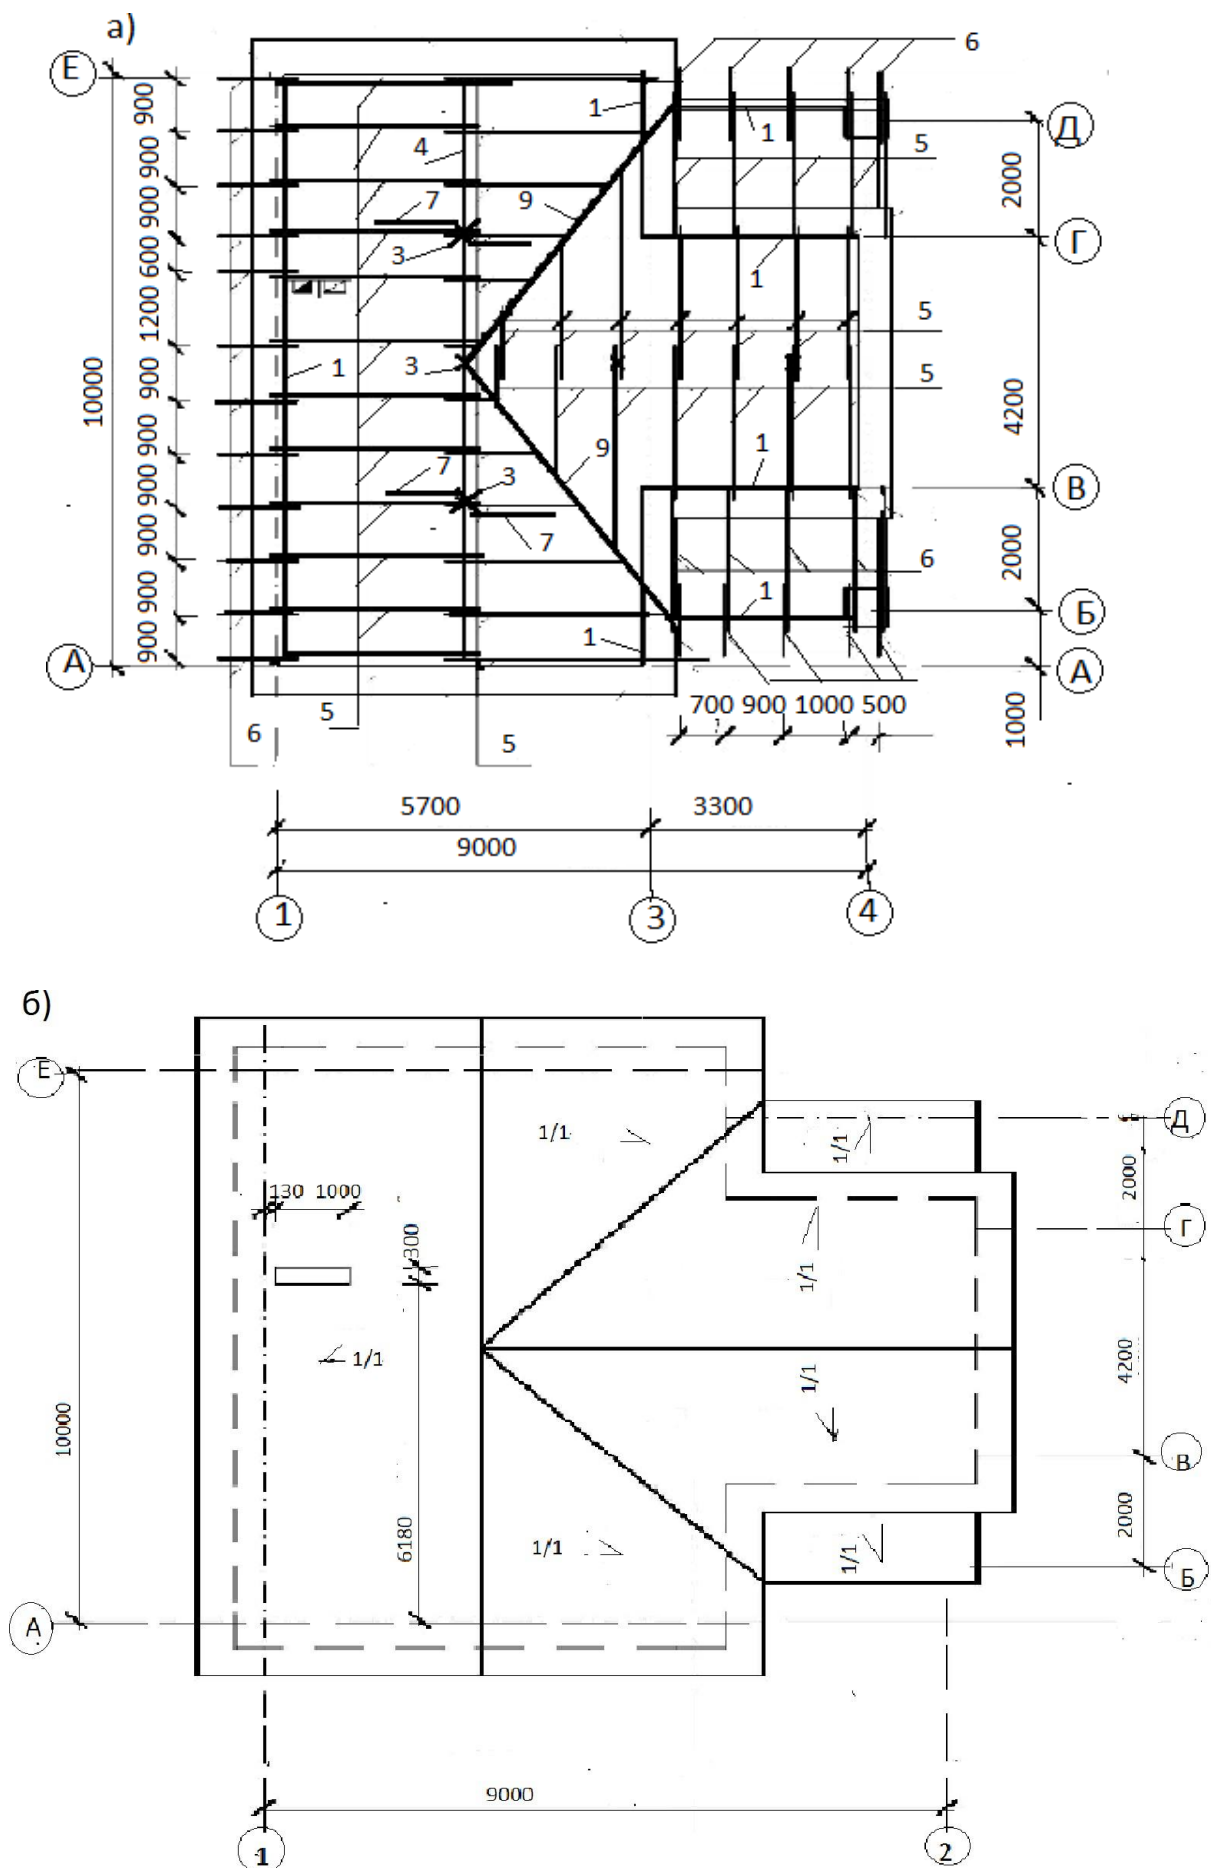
Схемы выполнения а) элементов стропил, б) кровли
